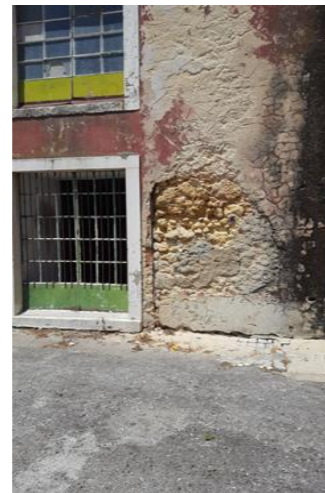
Destacamento de rebocos em fachada, fonte: Autor
